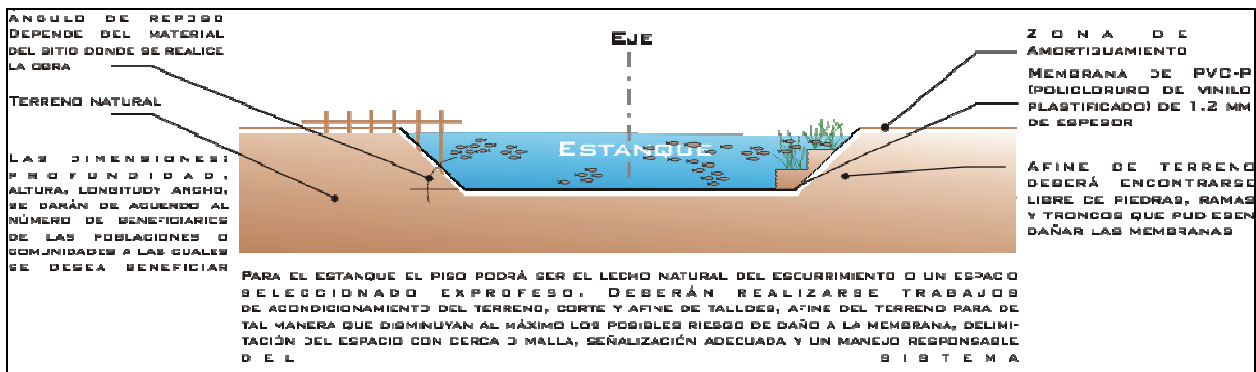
Corte longitudinal esquemático para la zona de trucheros
